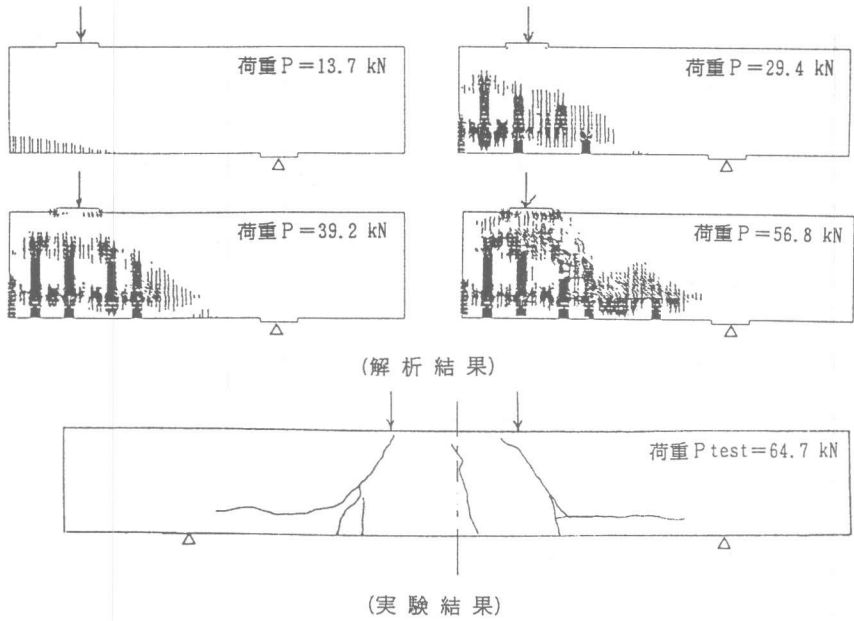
ひび割れ状況 (せん断圧縮破壊)
